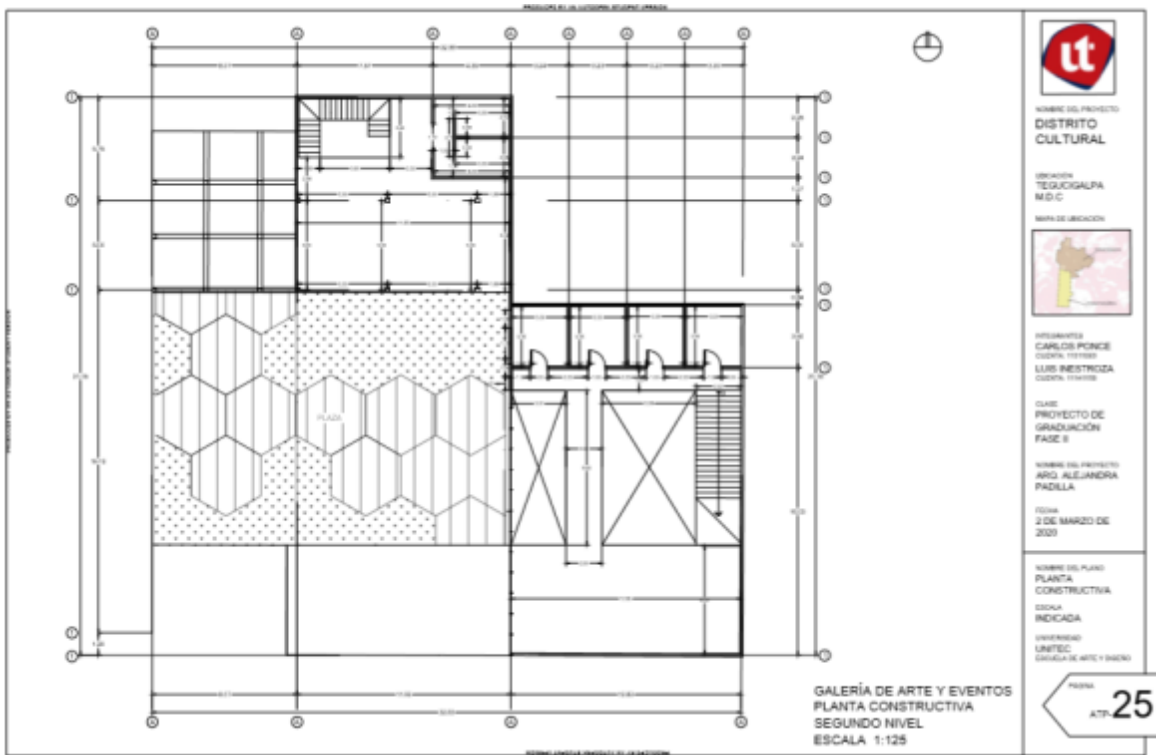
Planta Constructiva Galería de Arte y Eventos Segundo Nivel
